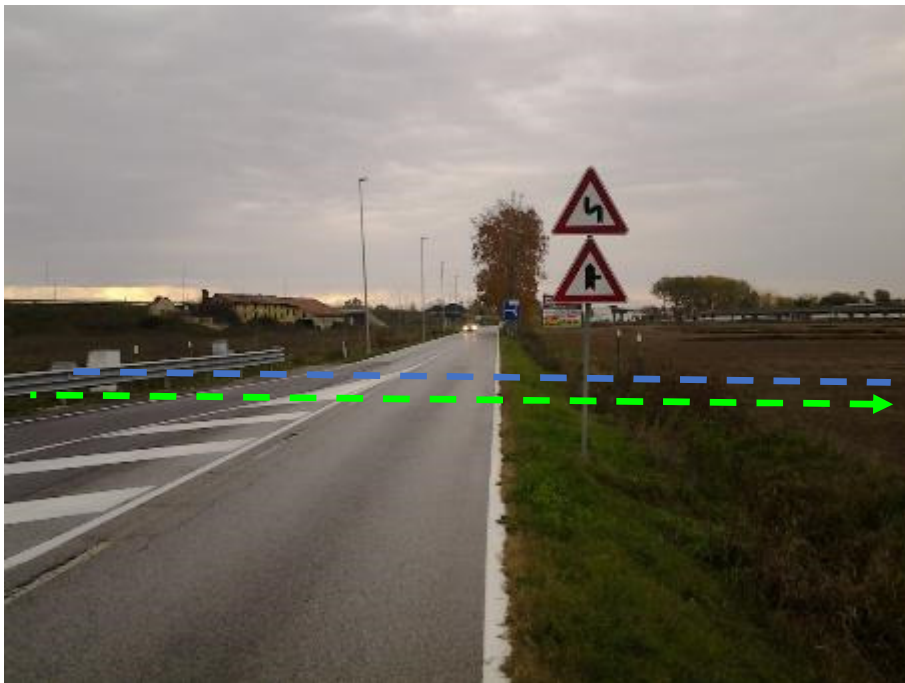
ATTRAVERSAMENTO S.S. N.14
